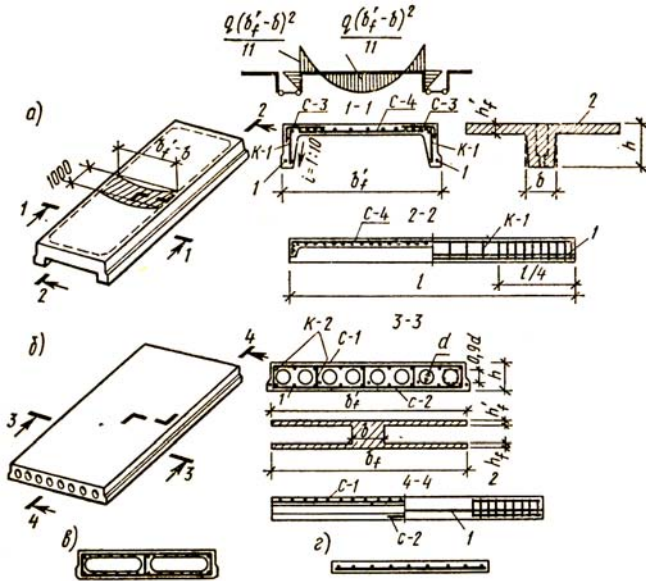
Конструкции сборных панелей перекрытия: 1 - напрягаемая арматура; 2 - расчетное сечение
